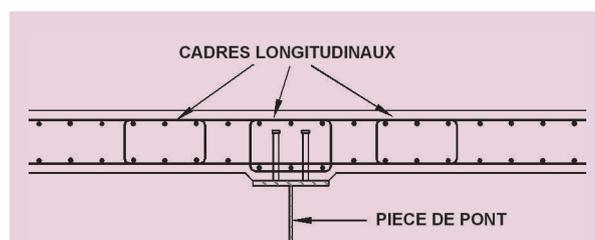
Cadres longitudinaux nécessaires au voisinage d'une pièce de pont
